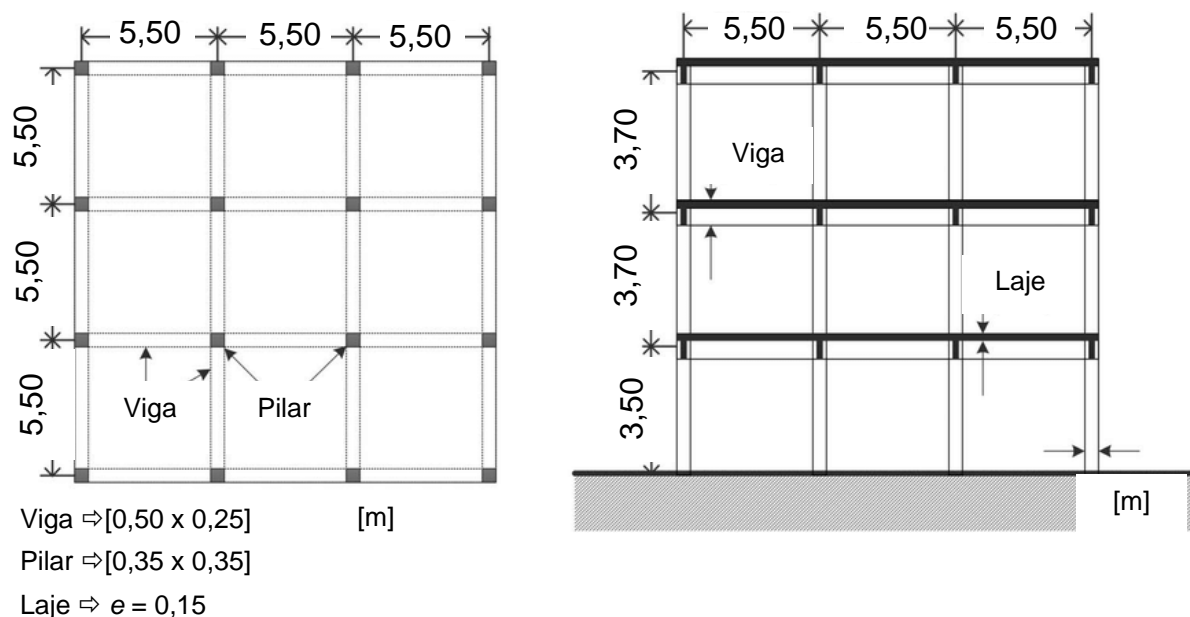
Planta e alçado frontal de uma estrutura porticada regular em betão armado, adaptado de [Google]
